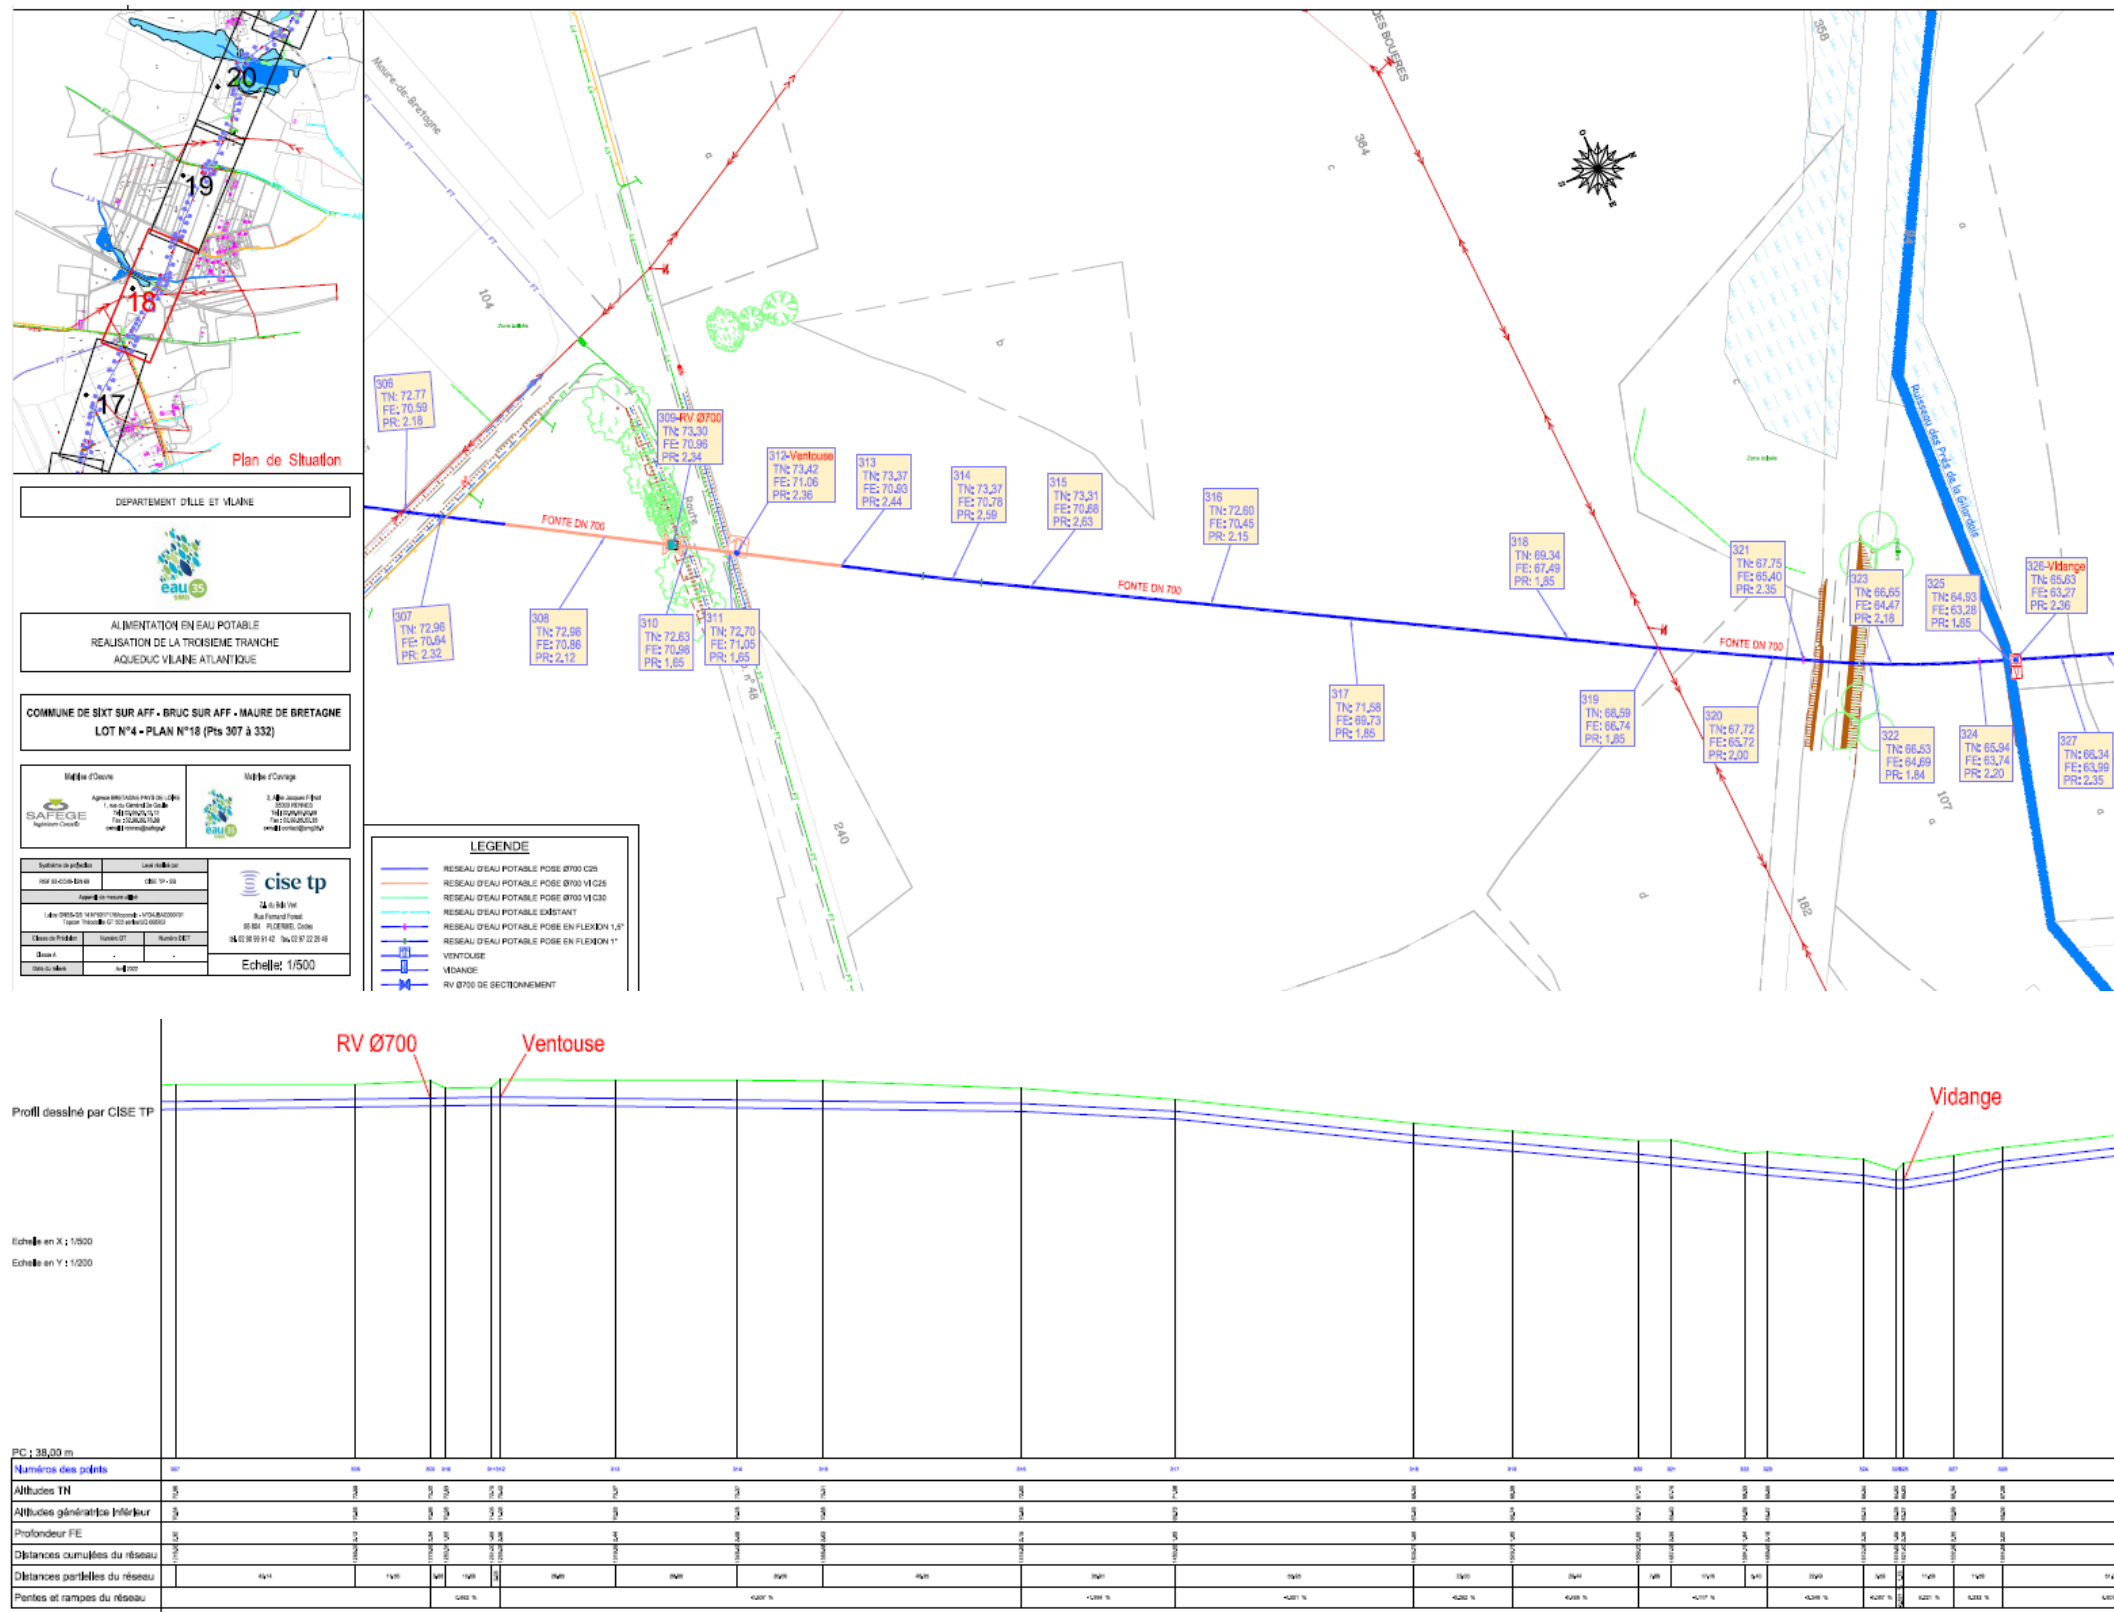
Plan et coupe d'exécution des travaux au niveau de la traversée en souille du ruisseau des Prés de la Gilardais (Lot 4 Tranche 3)
